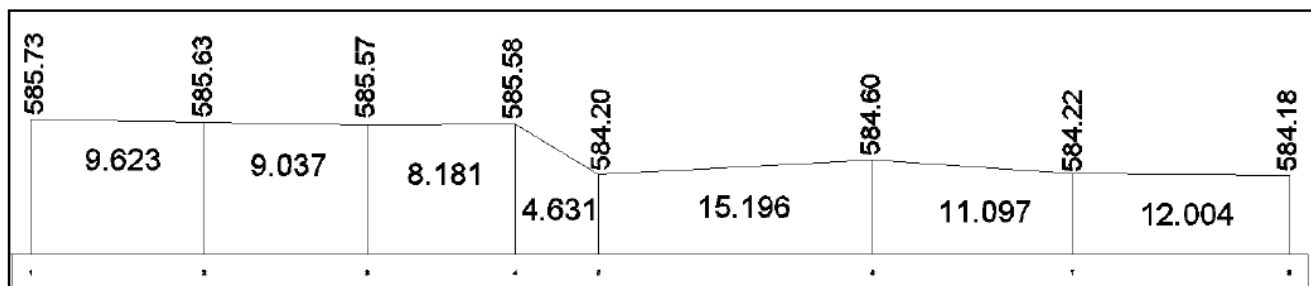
Profil en long actuel du seuil du pont Beau de Rochas (au centre de l'ouvrage)
